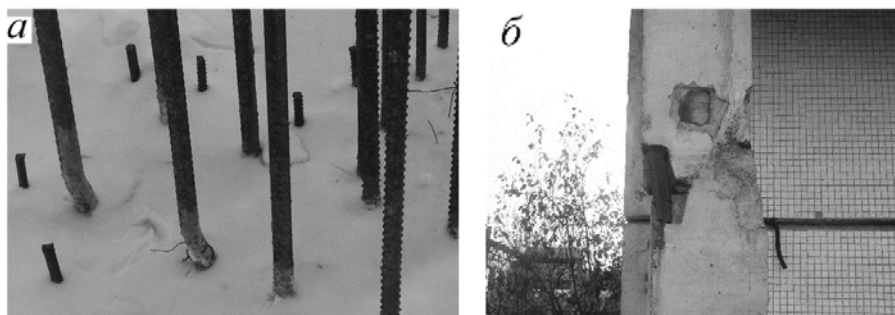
Нарушение геометрического положения стержней арматуры монолитных пилонов жилого дома на стадии строительства (а), смещение колонн смежных этажей относительно друг друга (б)
